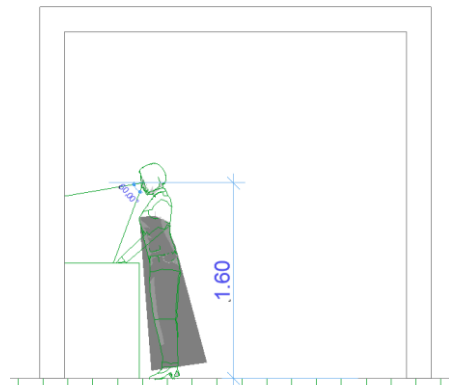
9 coupe dans la cuisine indiquant la hauteur de vue femme debout en face du plan de travail.
